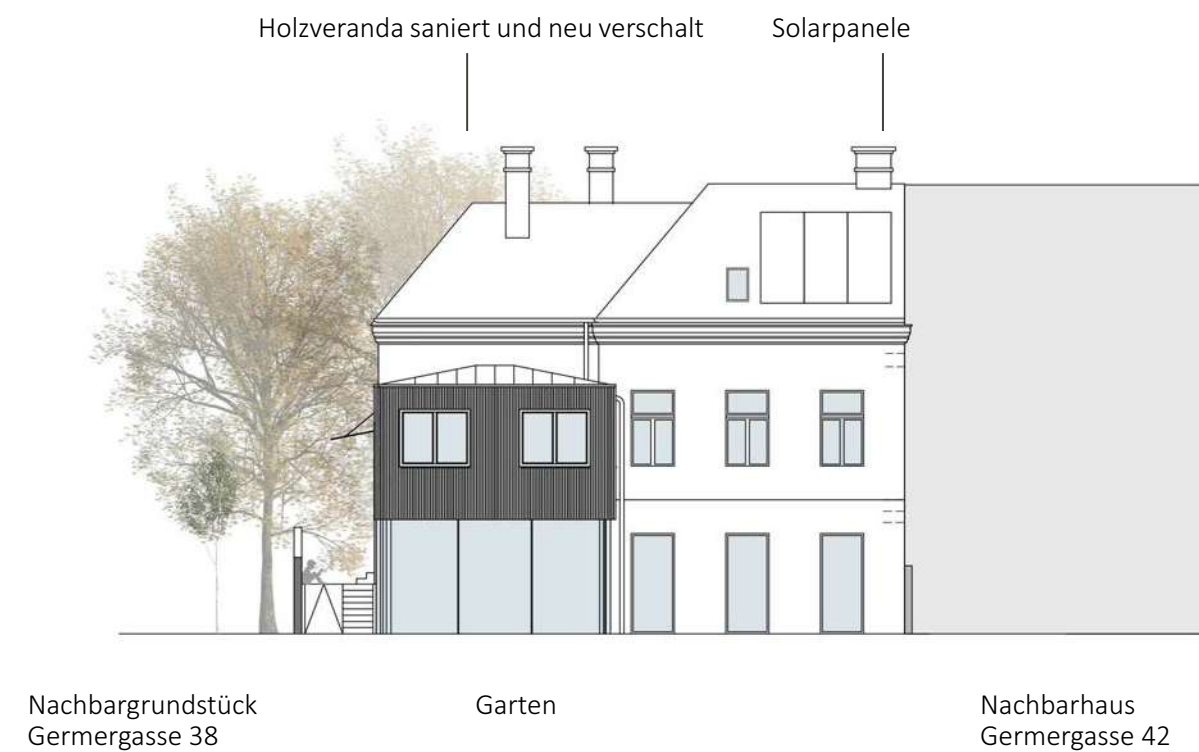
Ansicht Eingangsfassade, M=1:200.
